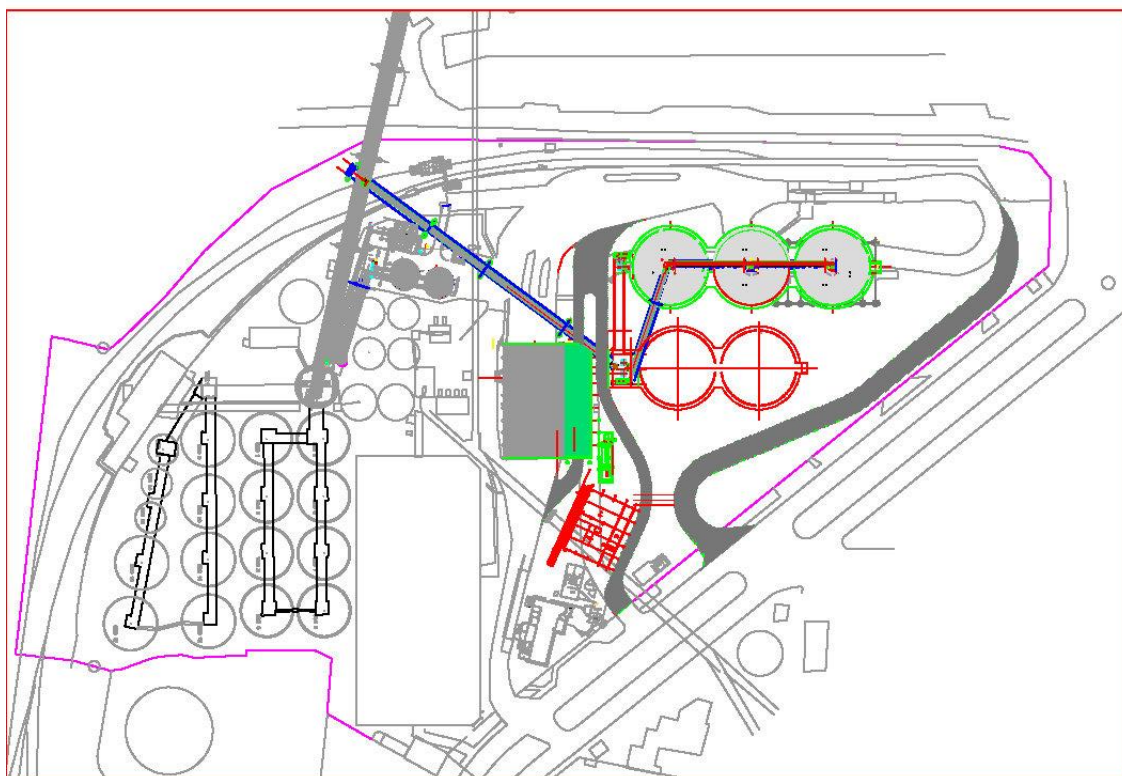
Plano general de la planta. Silos. Ver anexo II
